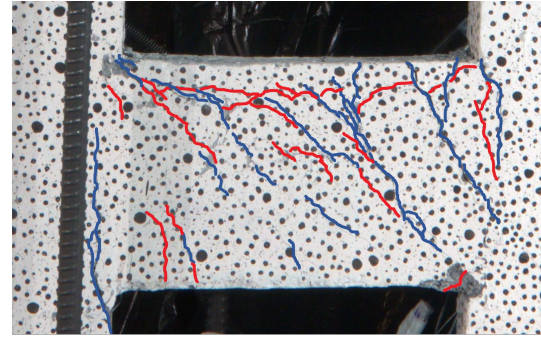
Grietas Vigas a 1.35 % Drift
